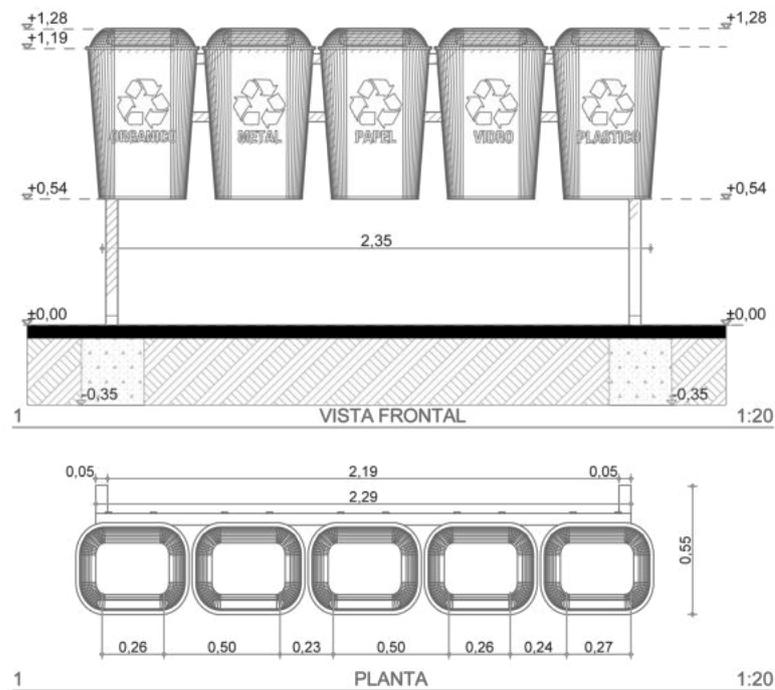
Planos 10 – Planta arquitectónica y alzado de basurero tipo 1. Fuente: elaboración propia Nota: Visualización de elevaciones y plantas arquitectónicas conformadas por basureros para su respectivo desecho
